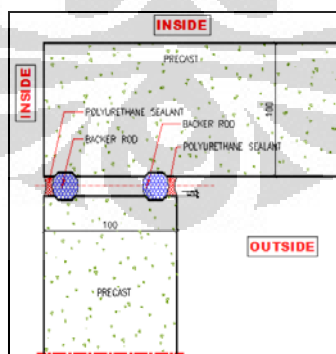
Detail Horizontal Sambungan Antar Panel
